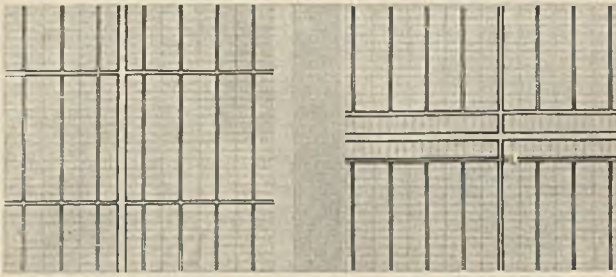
Dreifach abgestuftes Straßennetz mit Wohnstraßen gleichlaufend und senkrecht zur Verkehrsstraße.
